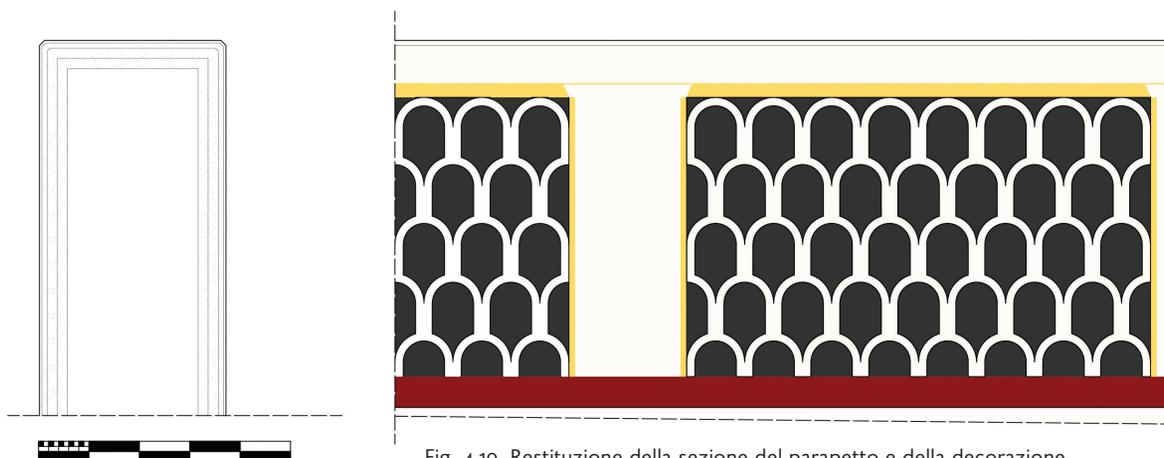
Restituzione della sezione del parapetto e della decorazione dipinta sulla parete interna (elaborazione grafica: Alessandra Pizzetti).
